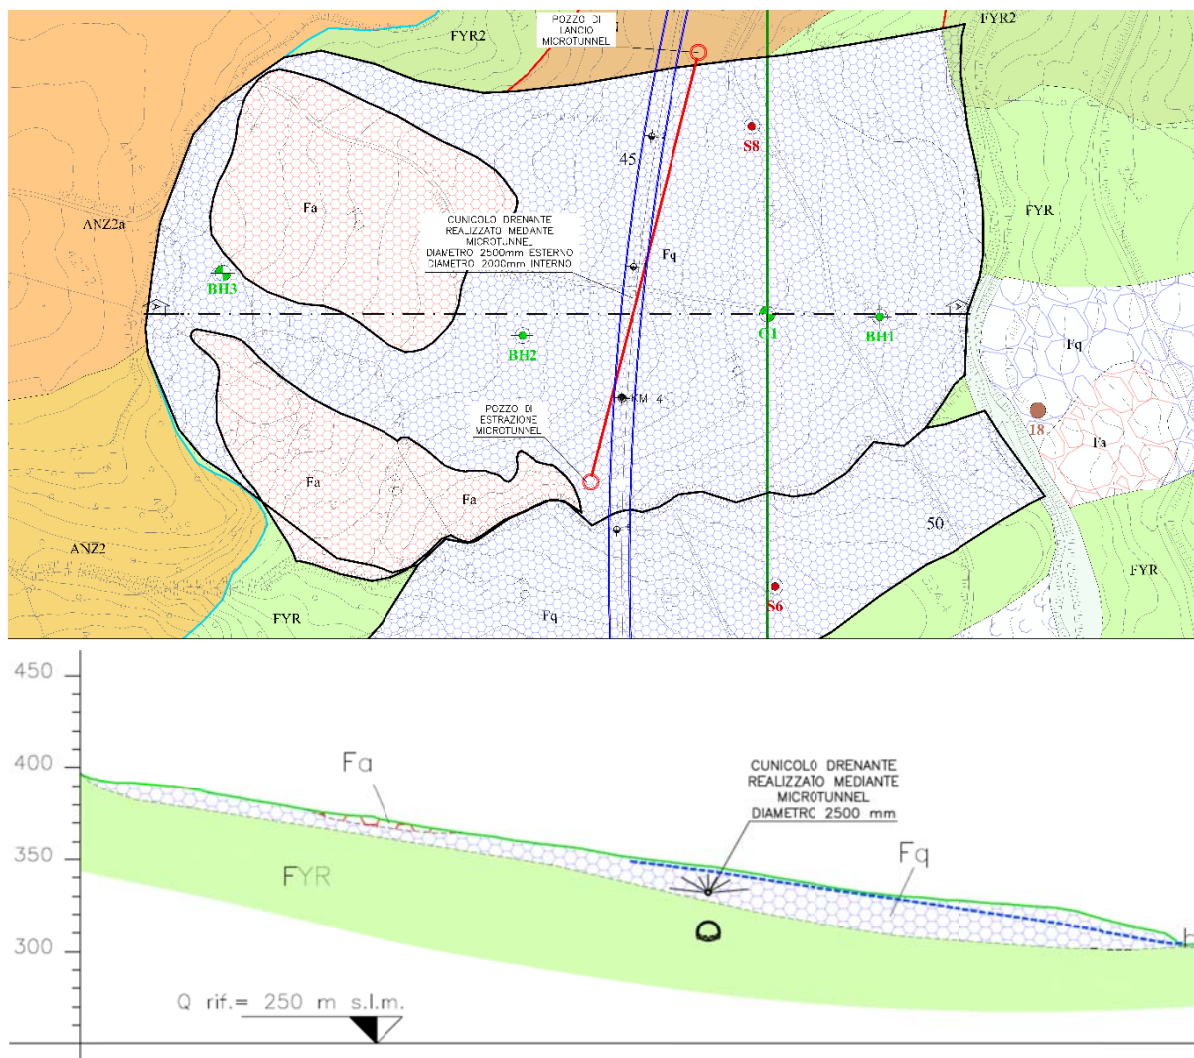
Planimetria e sezione dell'area di frana e dell'intervento con microtunneling
